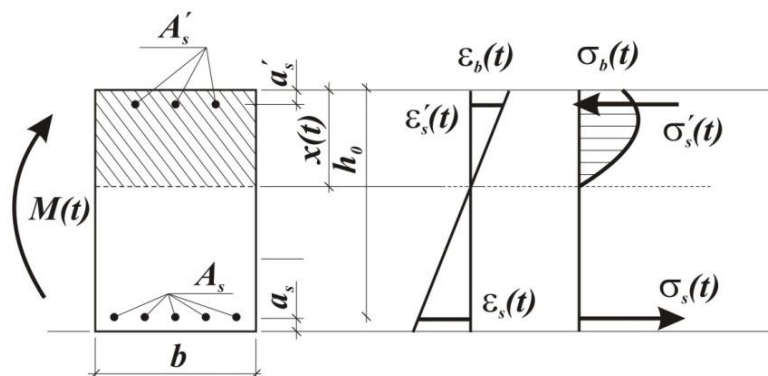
Расчетная схема железобетонного элемента с двойным армированием.
